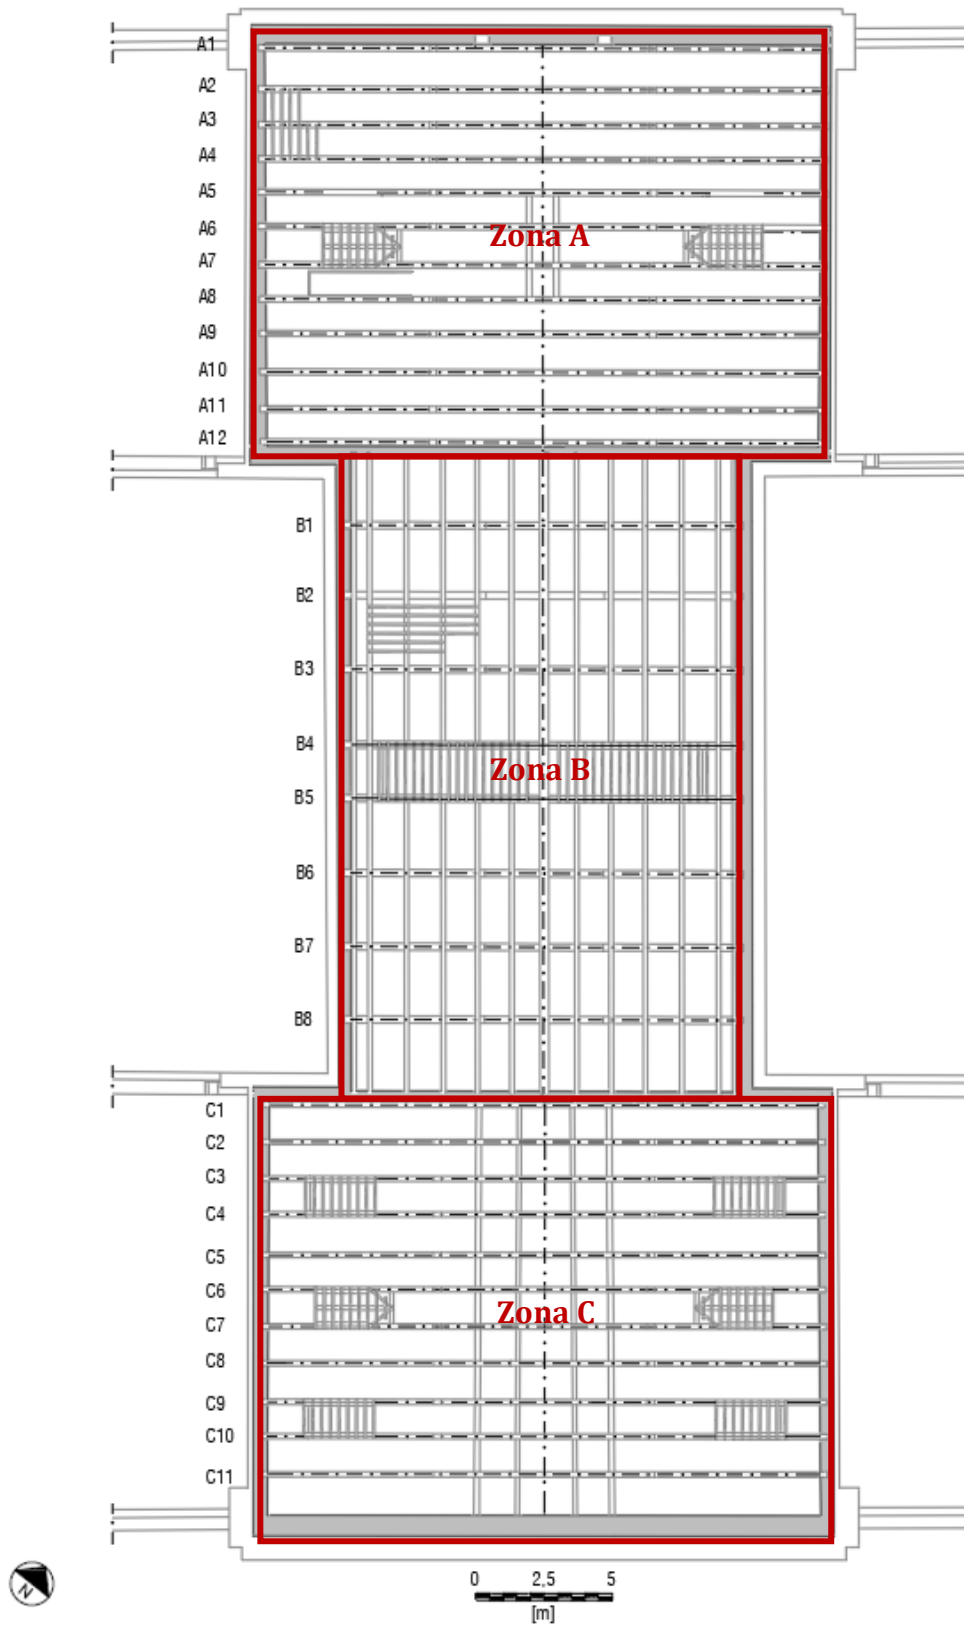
Individuazione delle zone A, B, C del sottotetto centrale di Villa Pisani.
